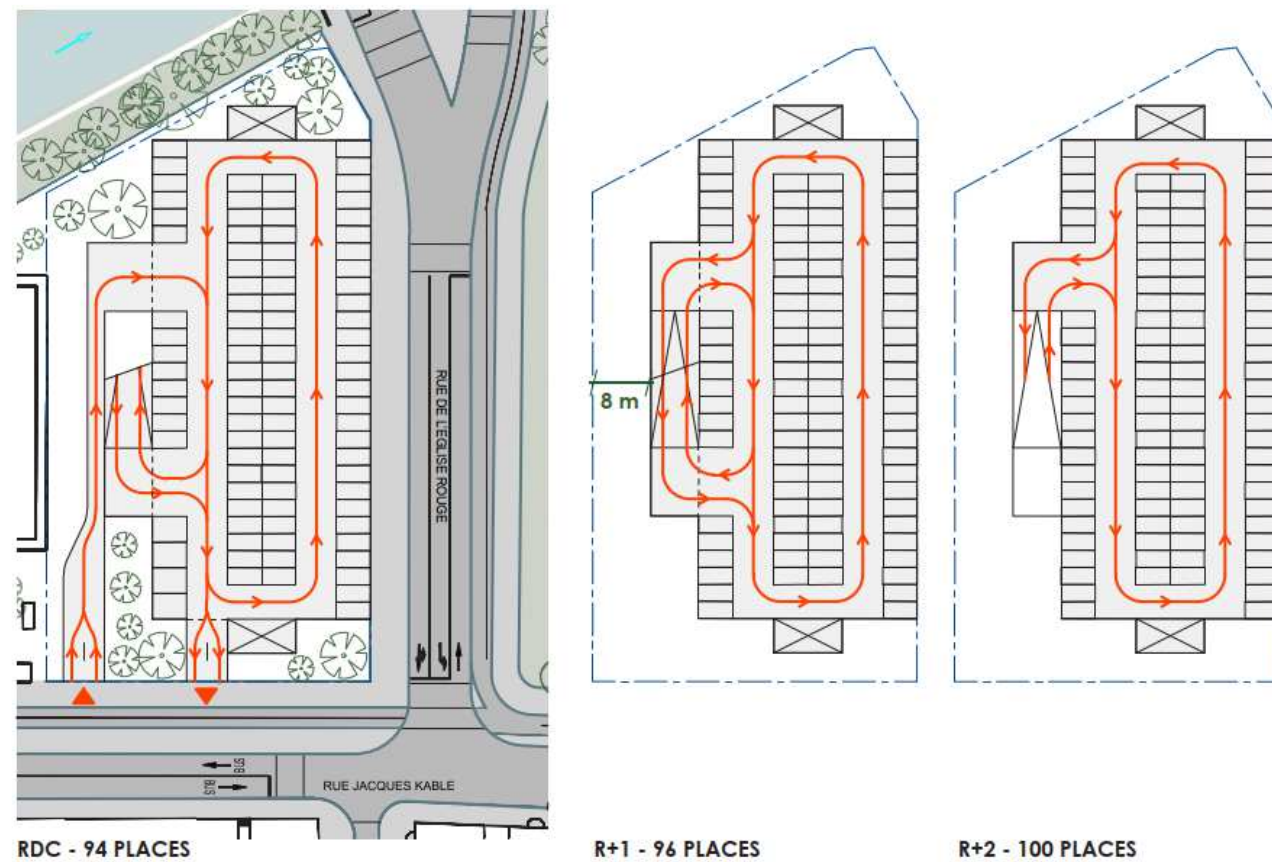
Proposition de plan des différents niveaux du parking Eglise Rouge
